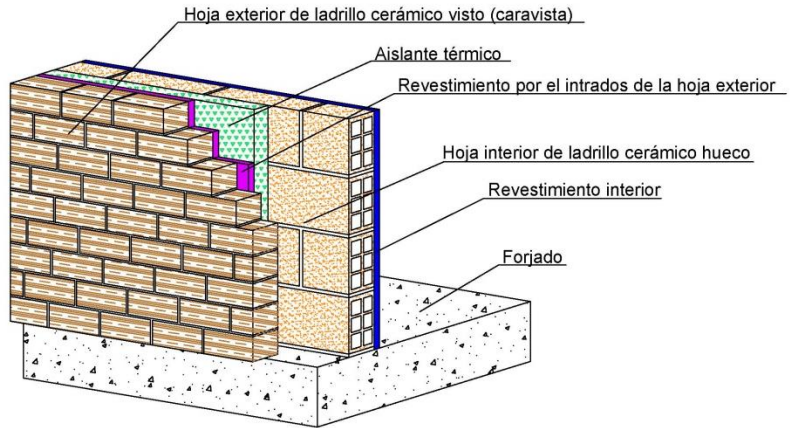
Detalle de fachada caravista de dos hojas. Abril 2015.
